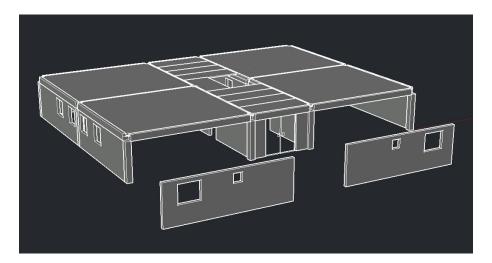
Representación de la inclusión de paneles prefabricados, a un sistema previo de pilares, vigas y losas. Fuente: Elaboración propia.
